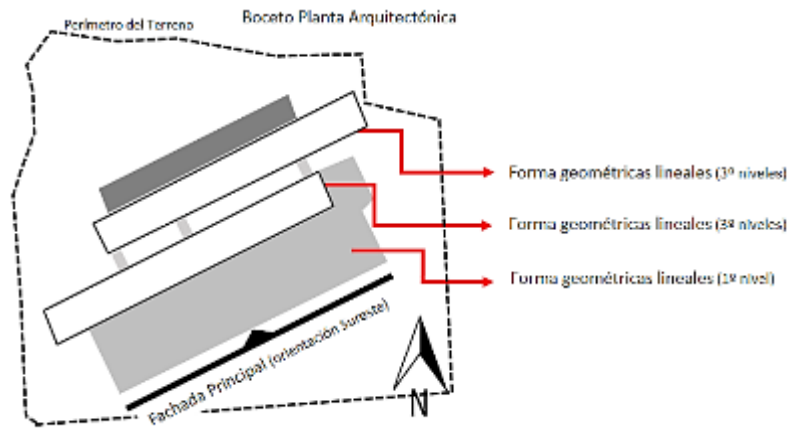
Boceto planta arquitectónica caso 1. Fuente: Elaboración propia
